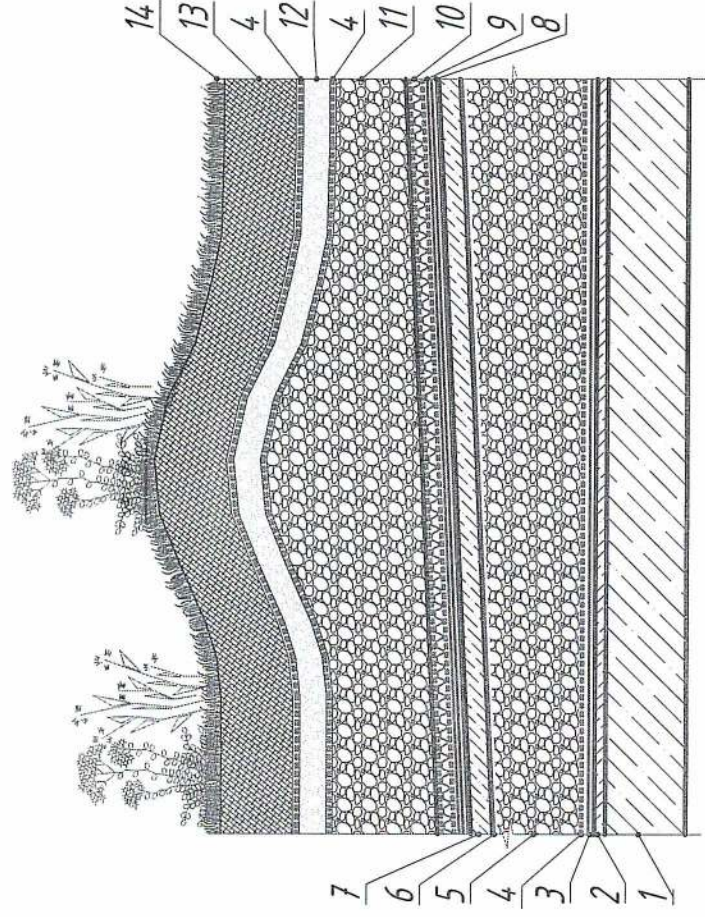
Принципиальная схема конструктивного исполнения настила бесчердачного покрытия выполняемого по железобетонному основанию (эксплуатируемая кровля с зелеными насаждениями)
